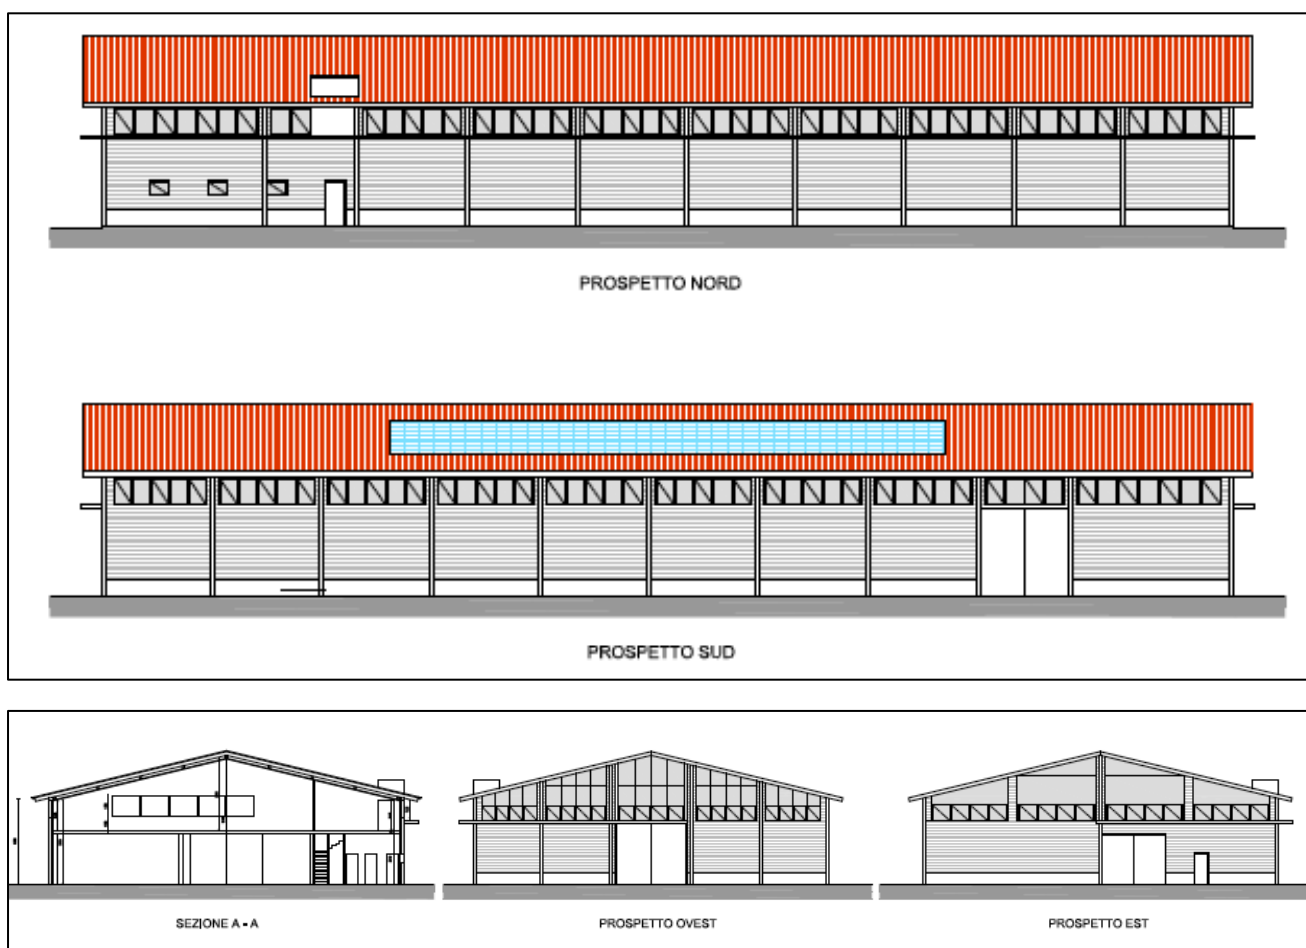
Prospetti e sezioni (estratto tavola 7 progetto prospetti)
